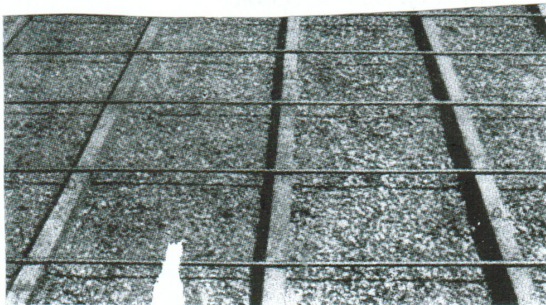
De doortlopende voorgespannen betonribben en de dwarswapeningsstaven daar loodrecht op.
